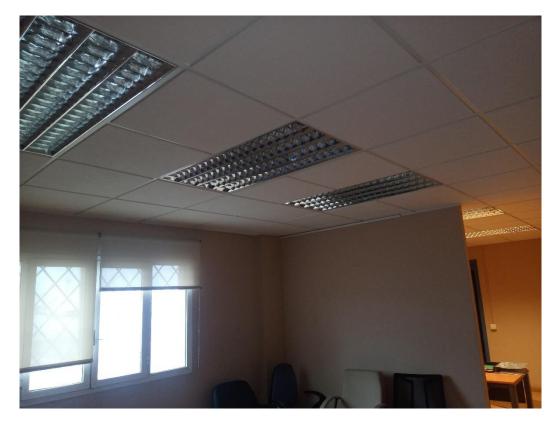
Detalle iluminación Planta Baja, Bloque Oficinas 2
